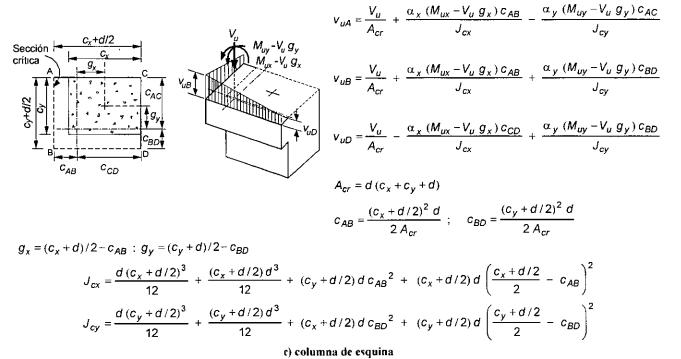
Transmisión de momento entre columna rectangular y losa o zapata
